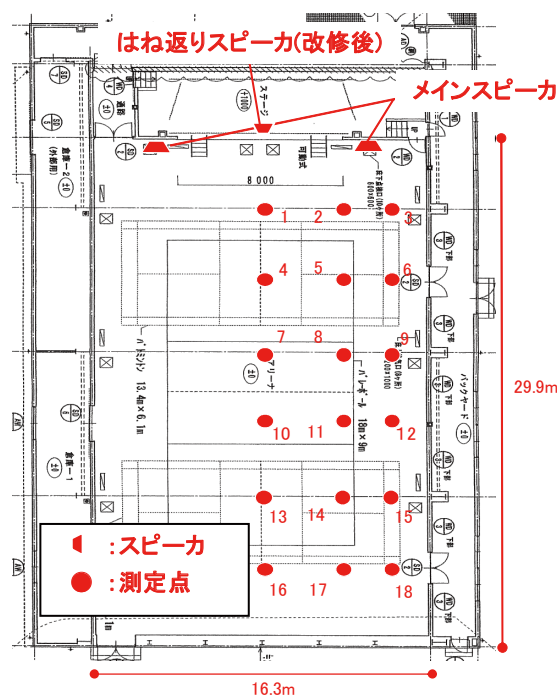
A 高校講堂兼体育館 平面図、スピーカおよび測定点位置
